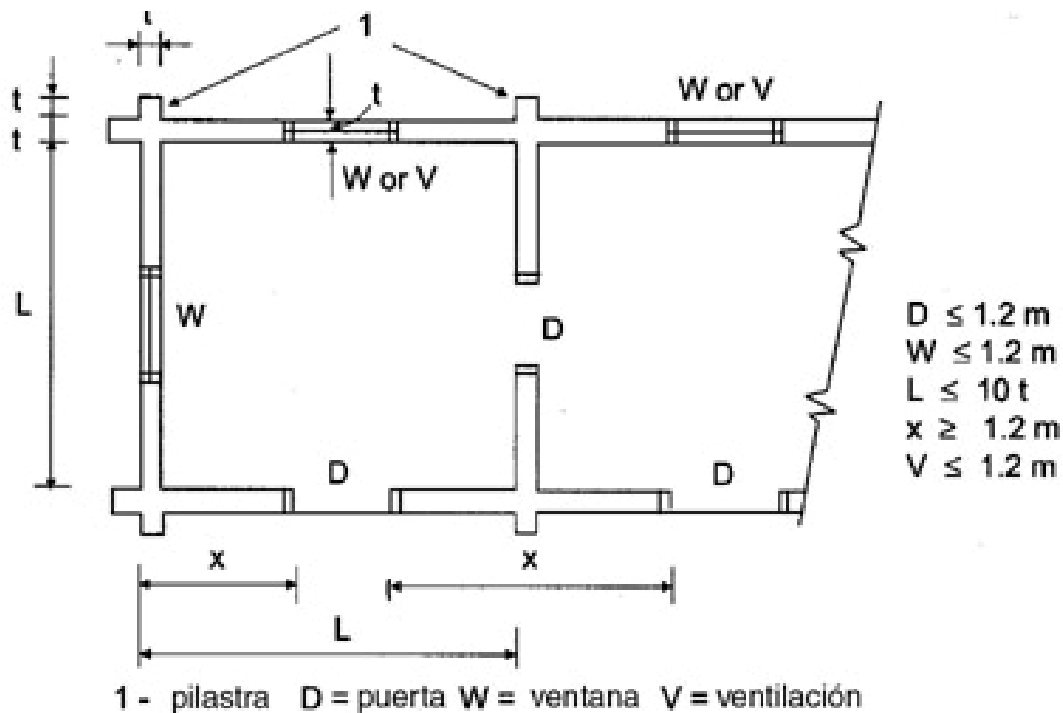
Guía para la Construcción de Muros con Contrafuertes y Pilastras.
